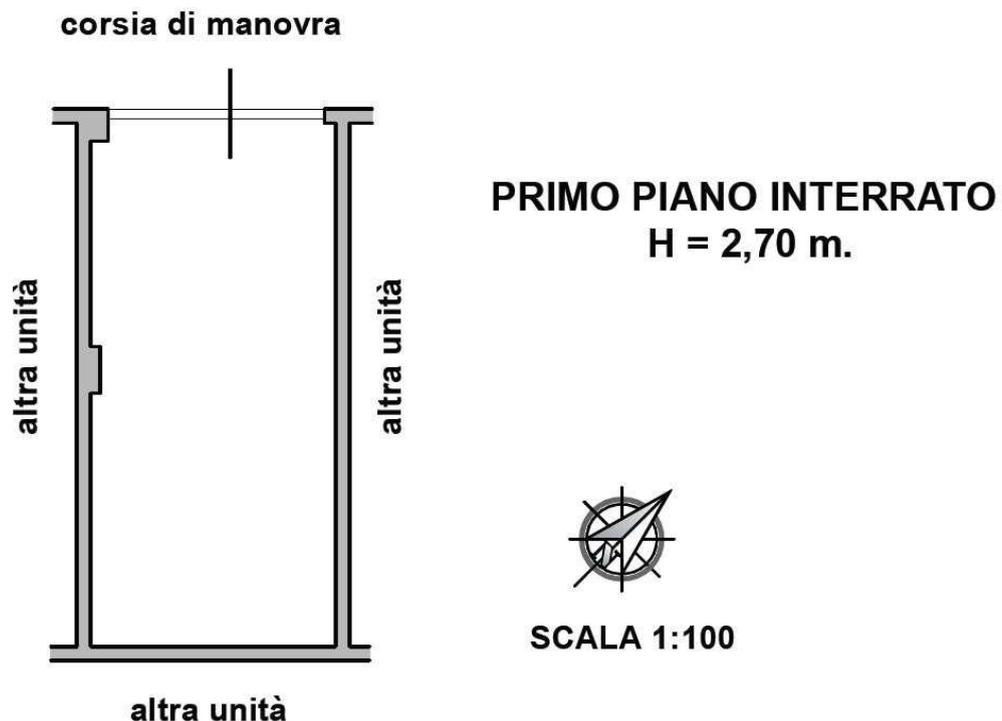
LOTTO 19 – Planimetria box auto foglio 76 – part. 620 – sub. 208
